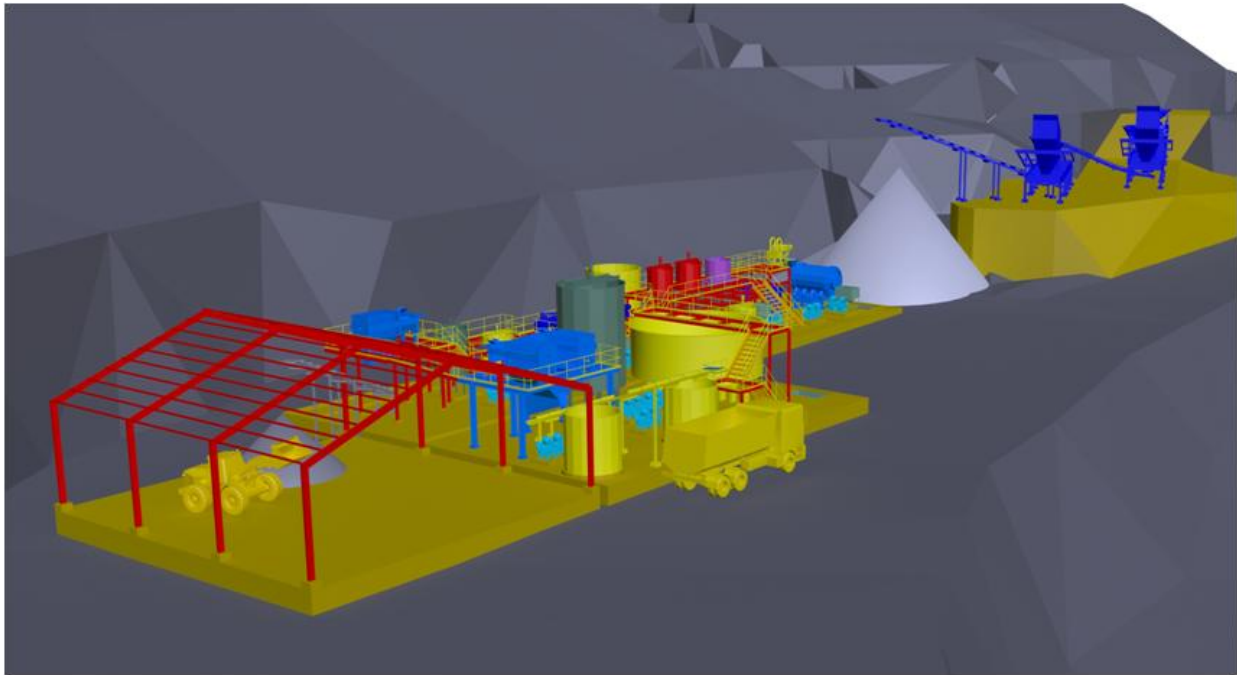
"Instalaciones de Operaciones Planta (referencial)"
